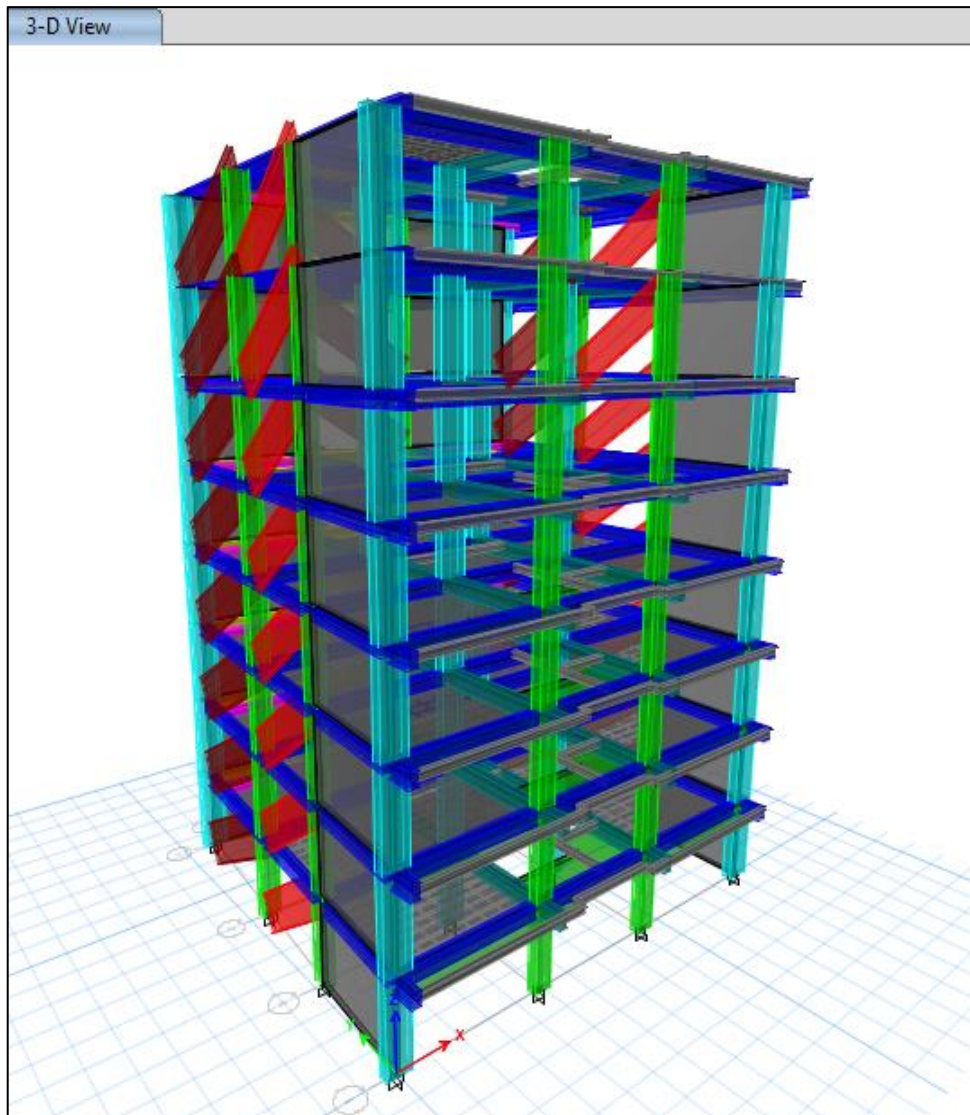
Modelamiento de concreto con tabiquería-King Kong.
